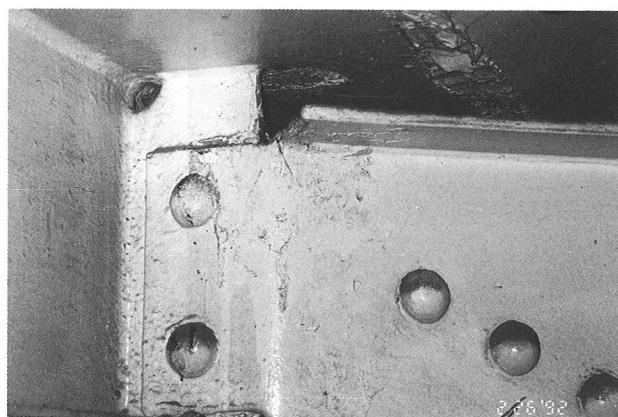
ガセットプレート折り曲げ部の疲労亀裂
